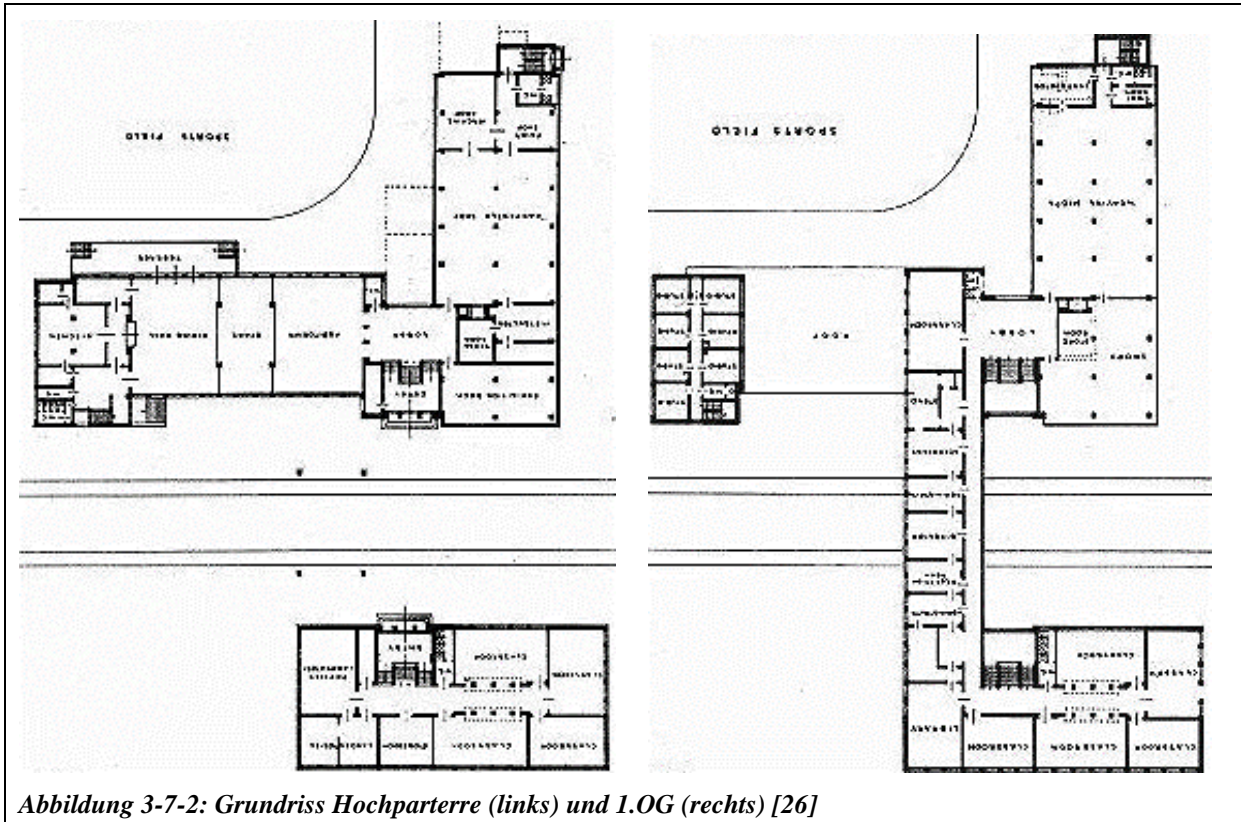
Grundriss Hochparterre (links) und 1.OG (rechts) [26]
